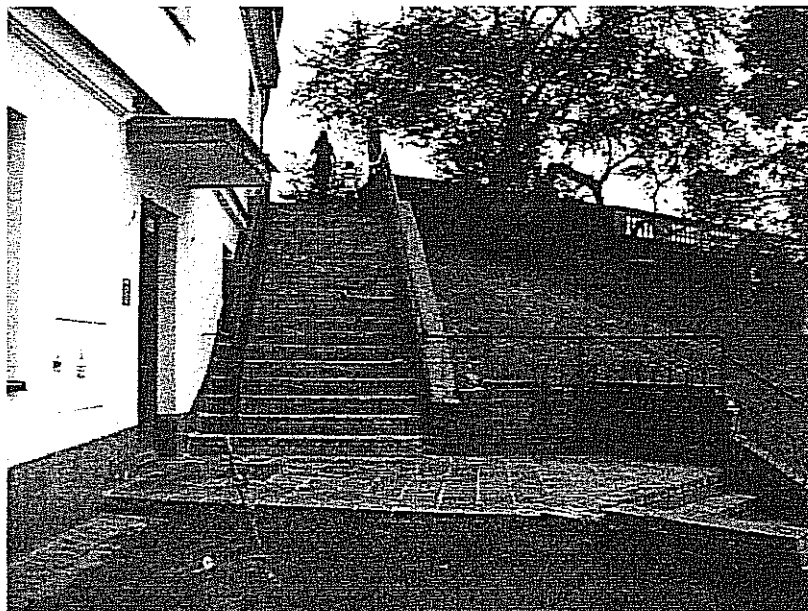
Widok na zniszczoną balustradę. Tymczasowe zabezpieczenie przed wejściem pieszych nie gwarantuje zabezpieczenia przed dalszym zniszczeniem kolejnych elementów balustrady i schodów. Widoczne odchylenie elementów balustrady.
